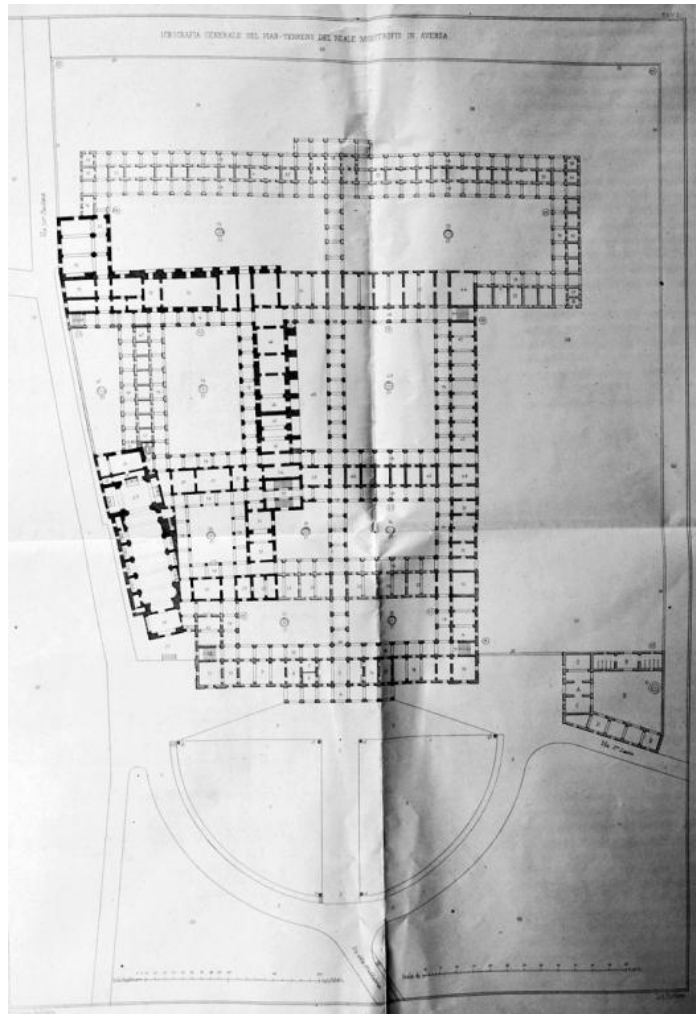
| Nicola Stassano, Planimetria del progetto di ampliamento e restauro redatto nel 1855.
